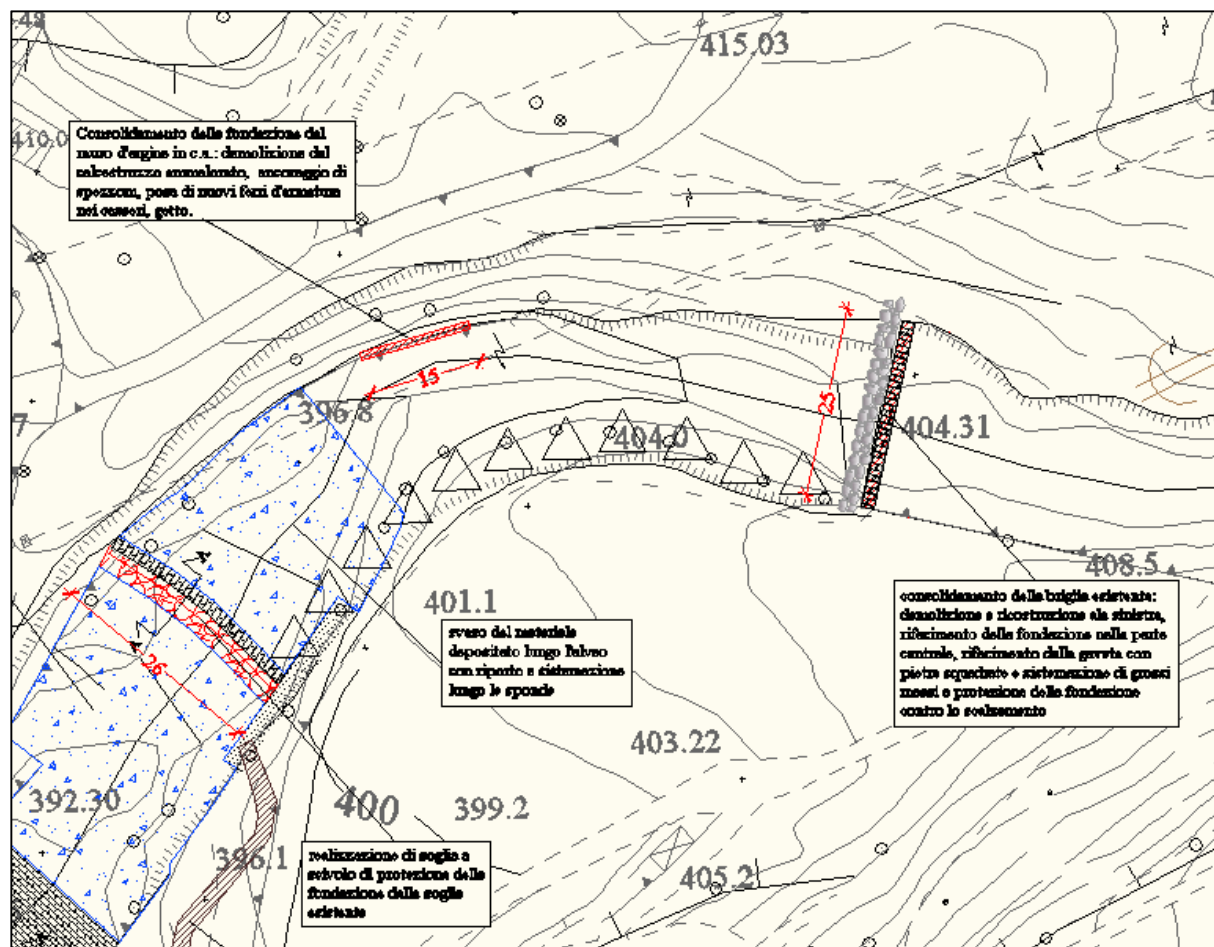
Estratto planimetria interventi in progetto parte alta (briglia esistente)
